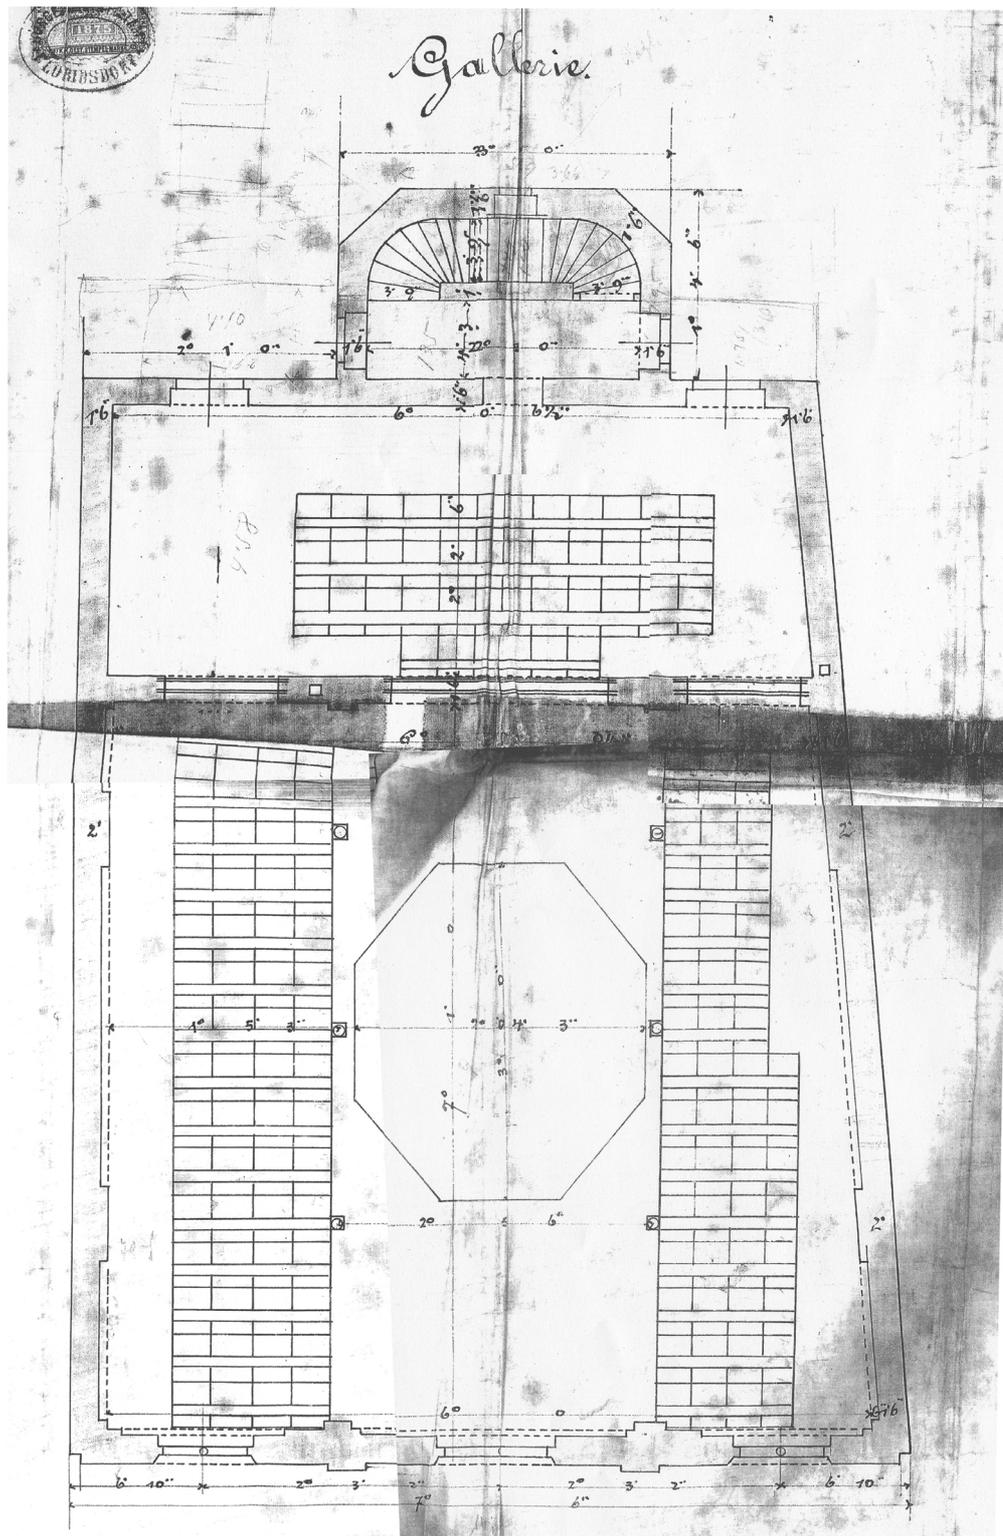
Grundriss des Obergeschoßes (Frauenempore), Jüdisches Museum Wien
